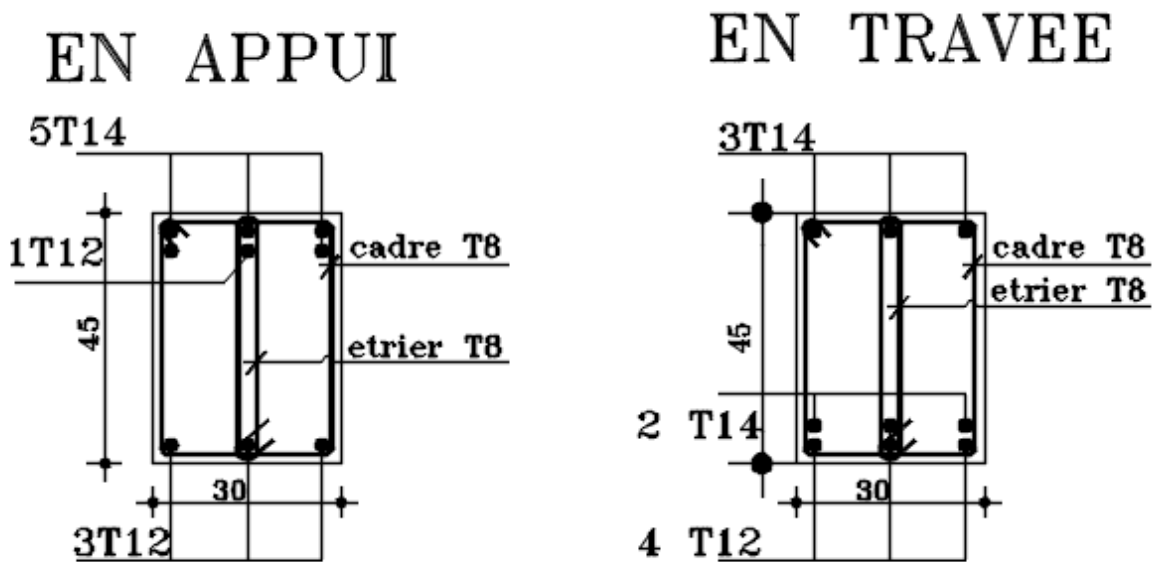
FERRAILLAGE DU POUTRE PRINCIPALE
